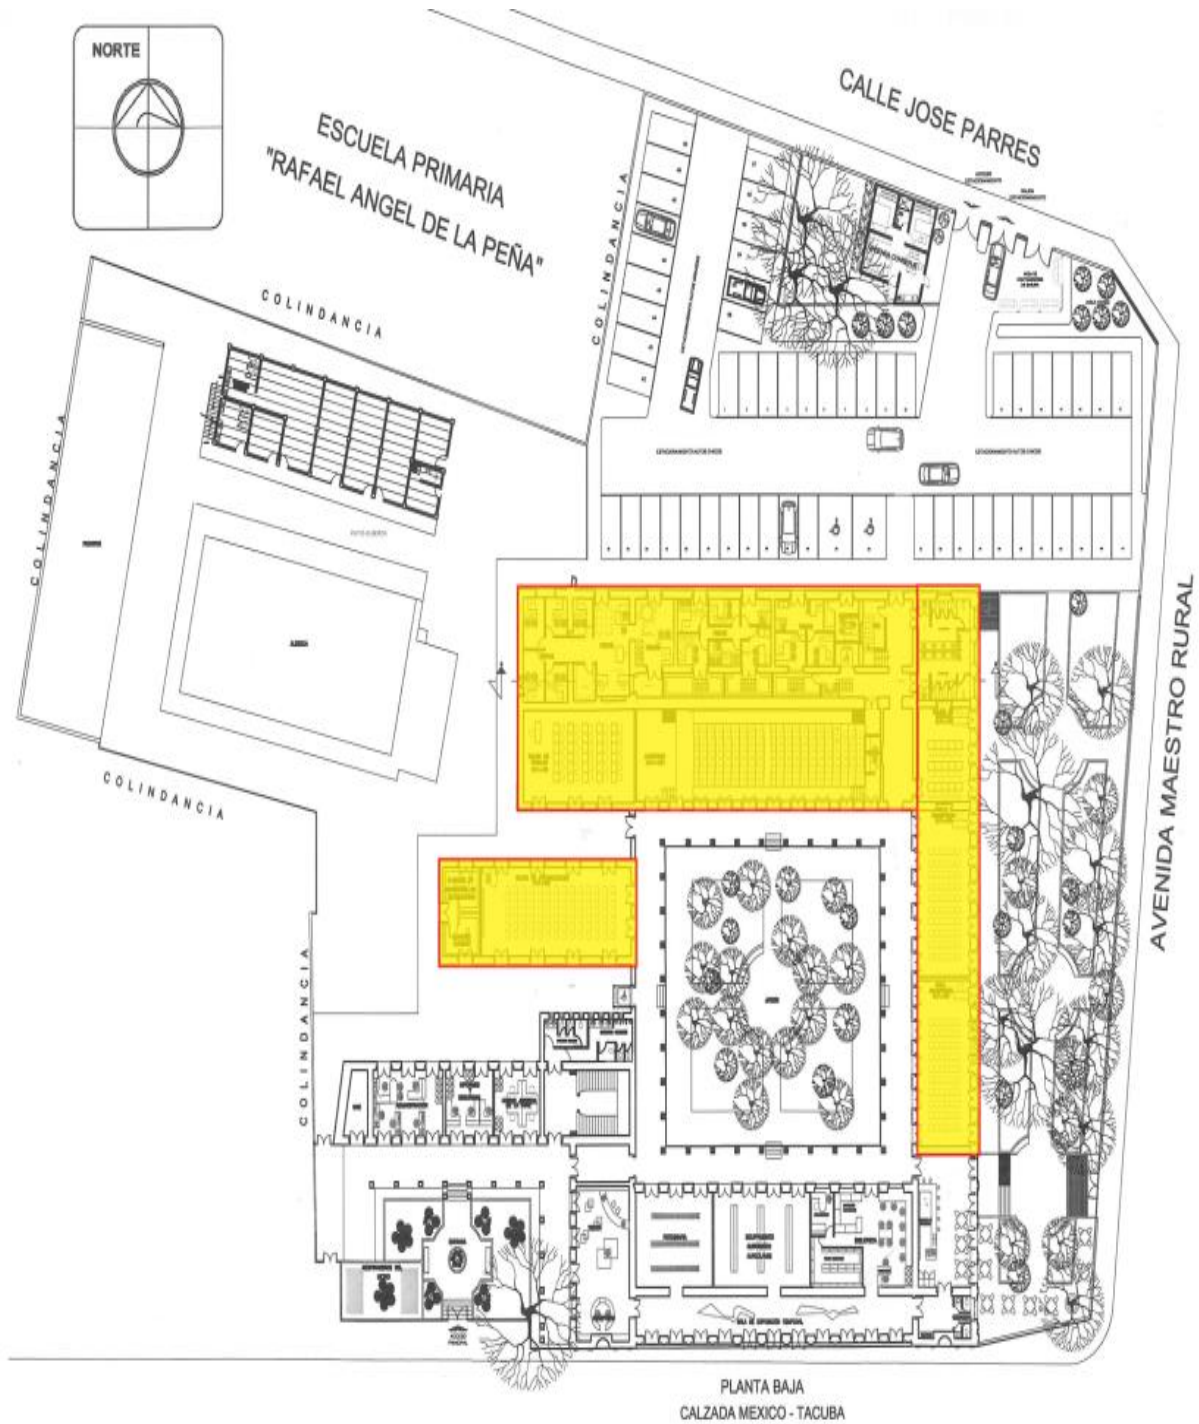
6 Cobertura MDF planta baja<sup>33</sup>
